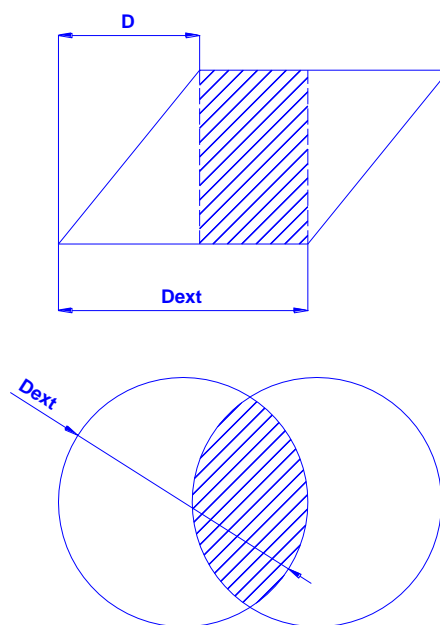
vistas en elevación y planta de aislador en posición deformada
